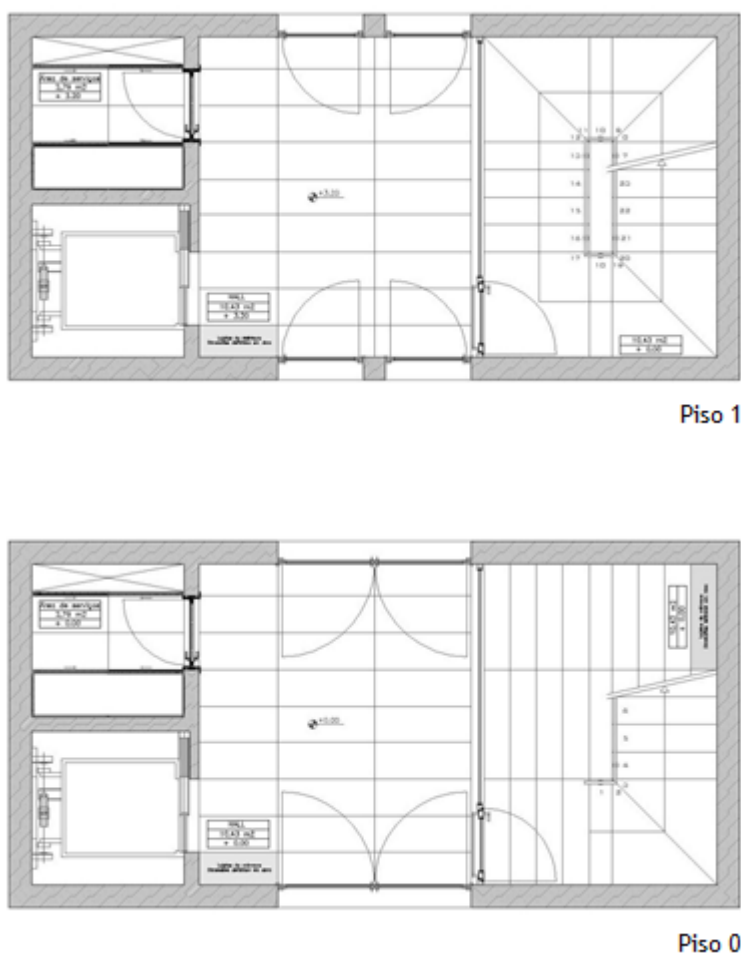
Torre. Planta piso 0 e planta piso 1.
